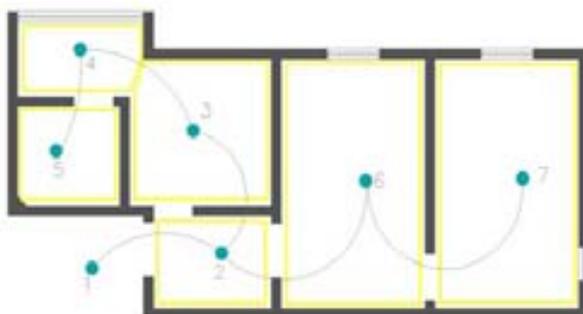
QELC 01, Bloco B9 - Planta Modificada
